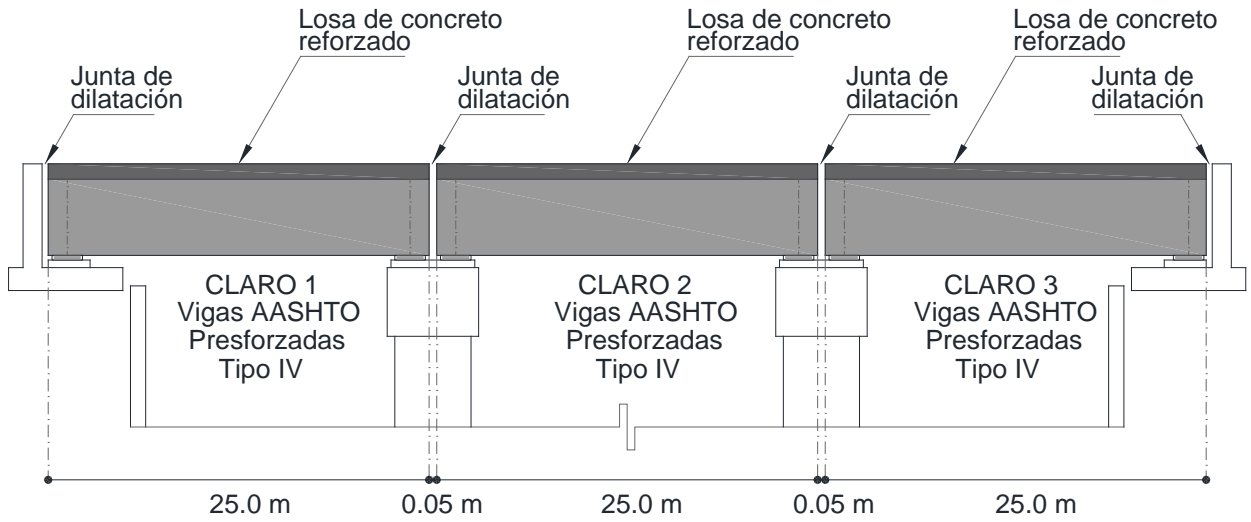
Corte longitudinal del Puente con juntas de dilatación.
